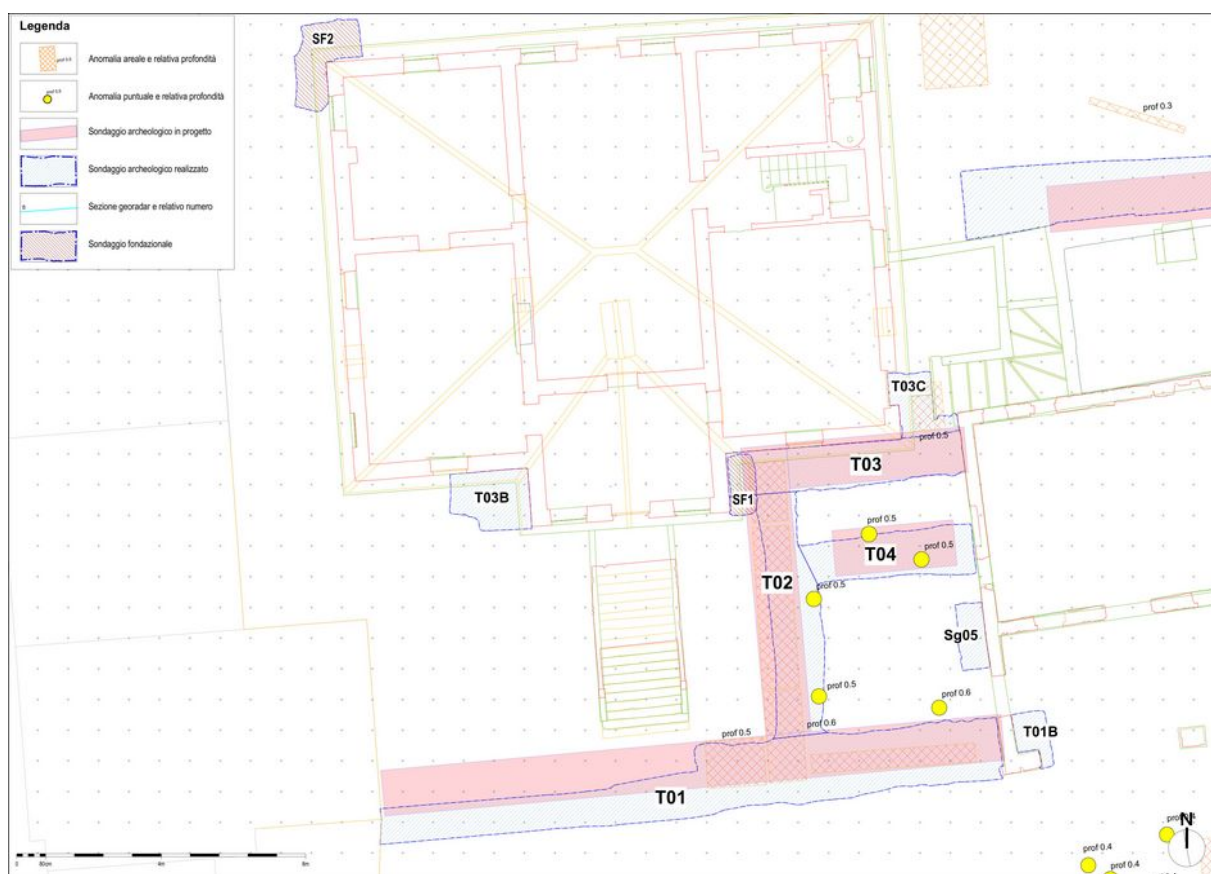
Area 2. Planimetria di raffronto tra le trincee progettate e quelle effettivamente eseguite.
